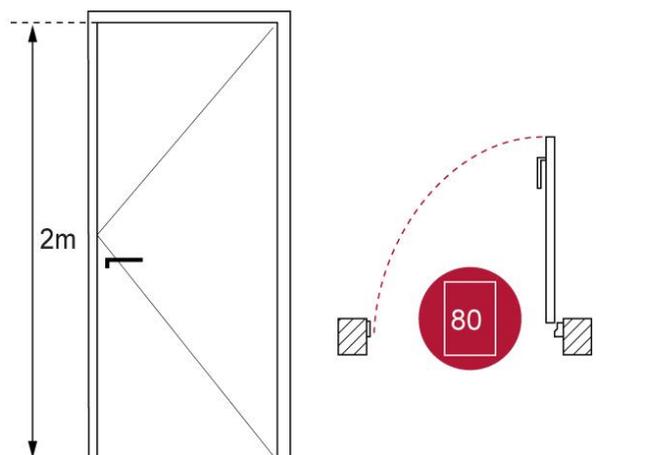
Ancho libre de puertas en los recintos de la vivienda
